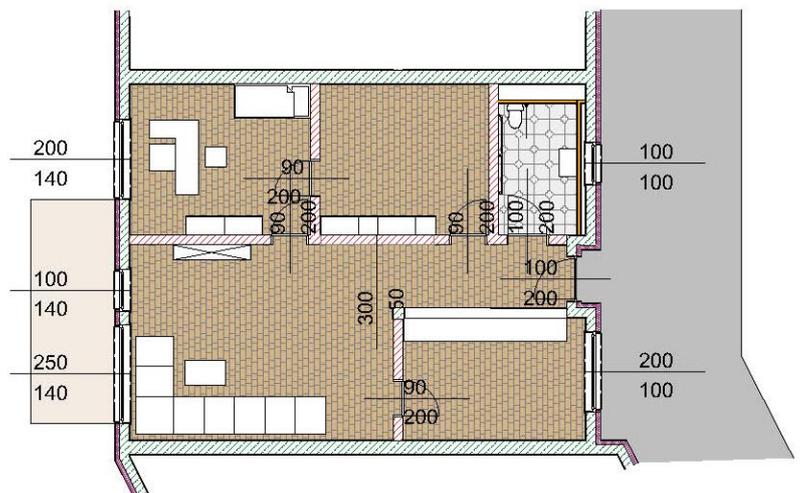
| Grundriss Arztpraxis Maßstab 1:200
